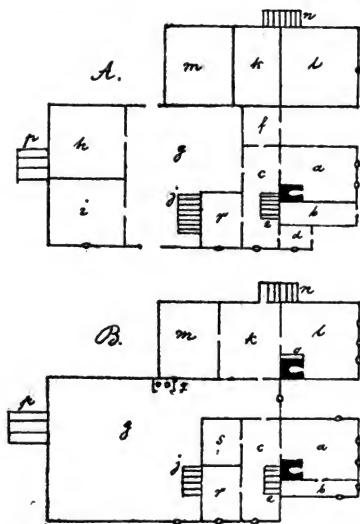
Grundrisse der beiden Stockwerke des vorigen Hauses.
